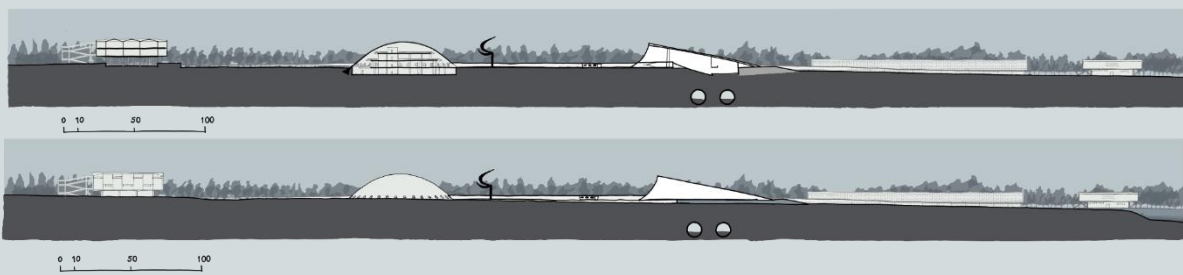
Corte e fachada – 2000 – Versão 8 – desenho nosso.
